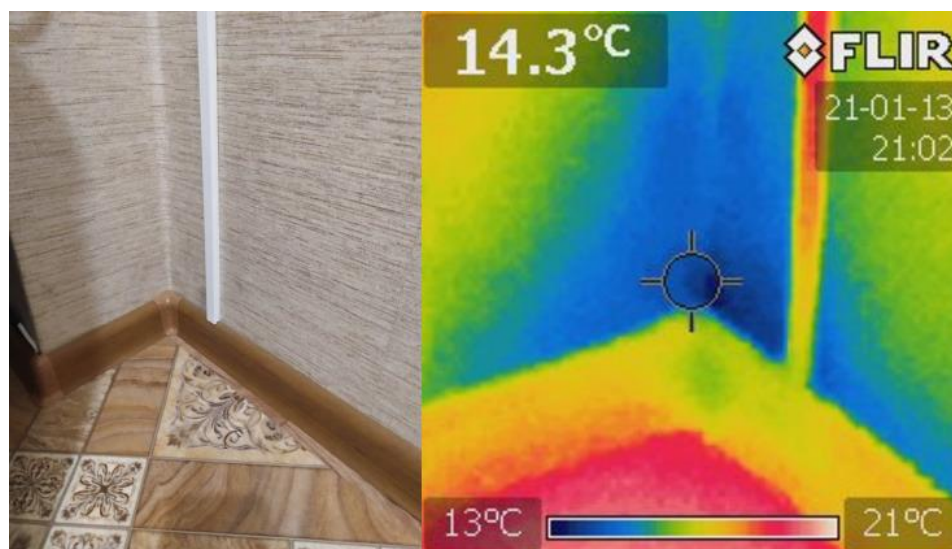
Термограмма стыка наружной стены и межэтажного перекрытия панельного дома
